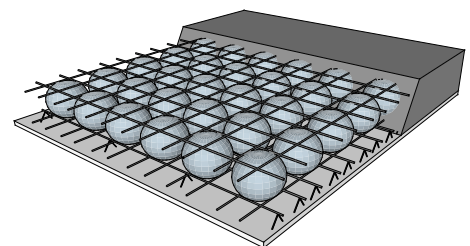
Konstruktionschema Hohlkörperdecke in Teilmontageausführung
